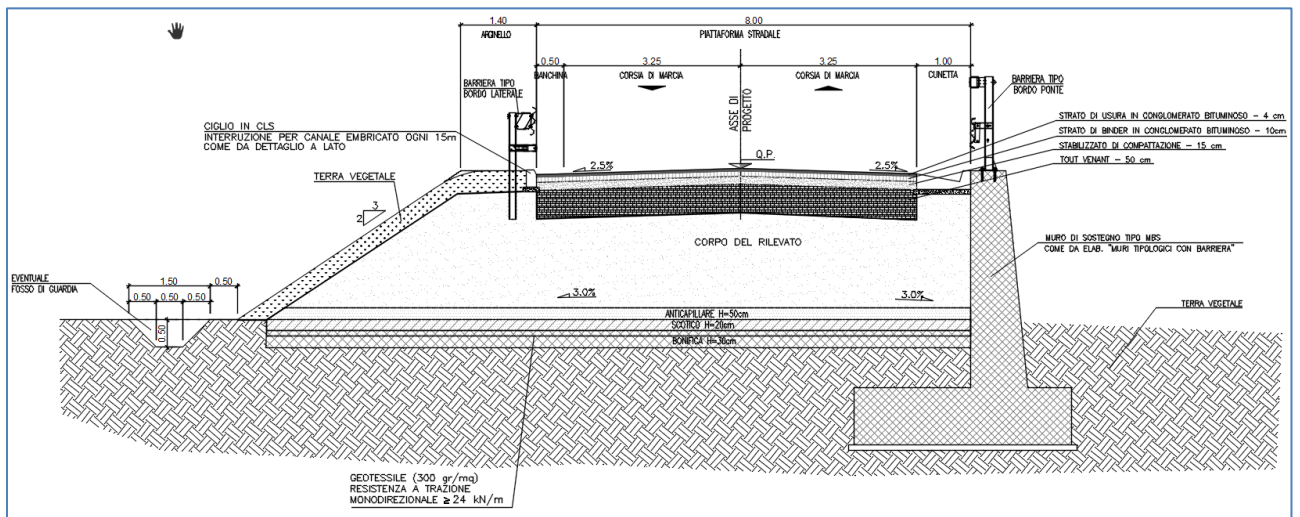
Sezione Tipo (caso particolare di muro su un lato)
